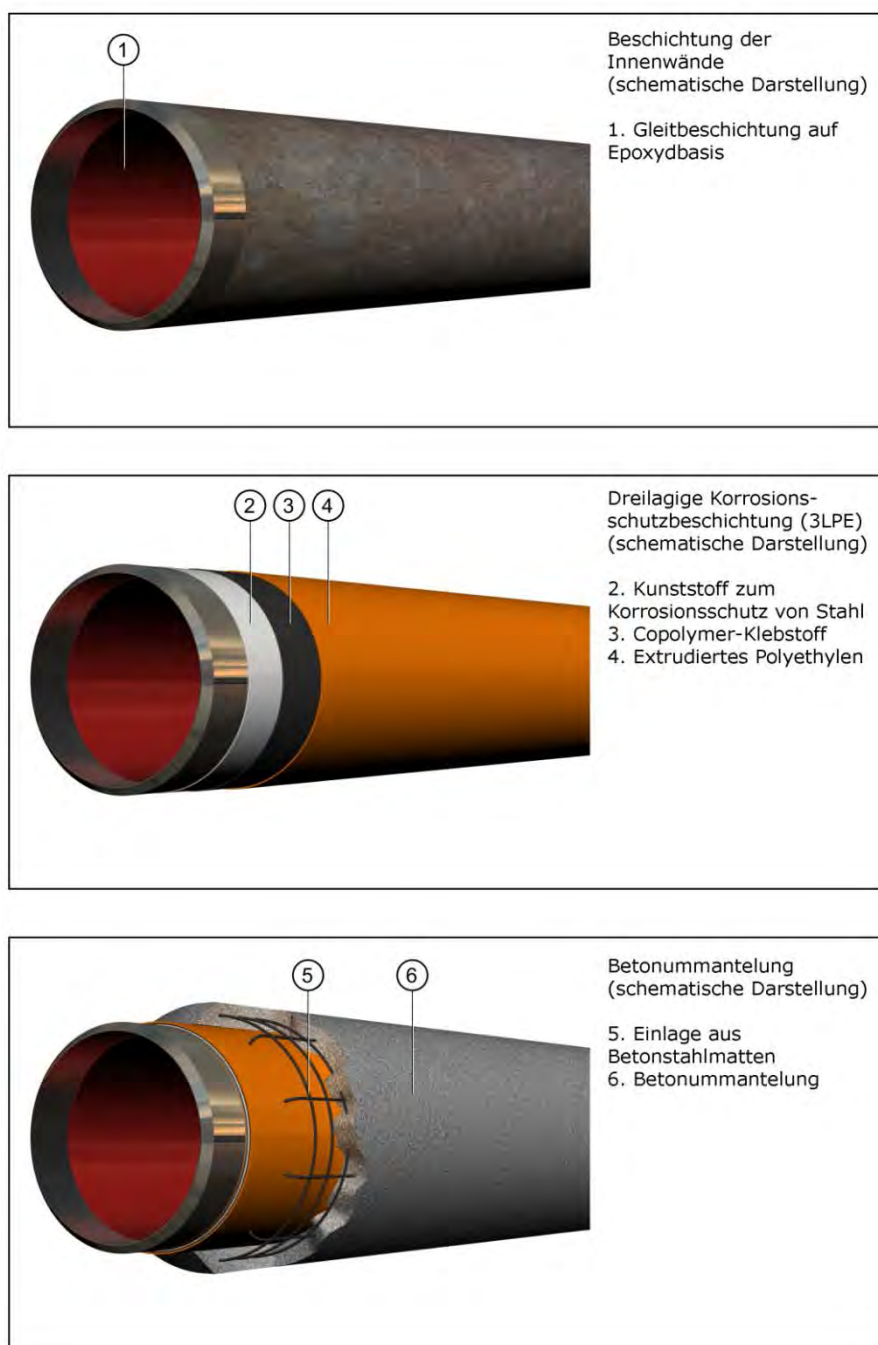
Aufbau einer Pipeline. Schematische Darstellung einer externen Korrosionsschutzbeschichtung und Betonummantelung.
